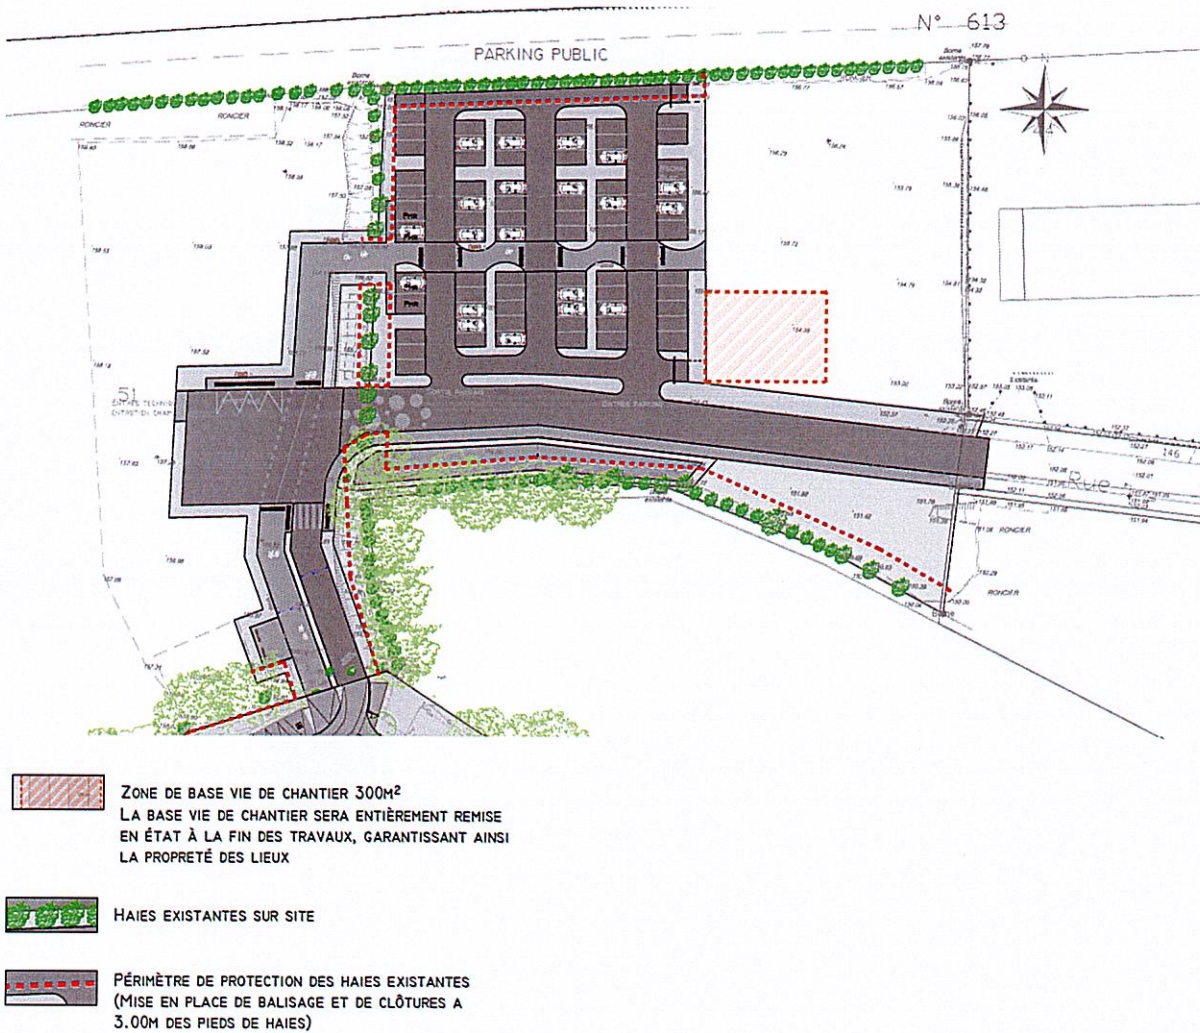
Extrait du plan de chantier de l'aménagement de l'aire de stationnement
